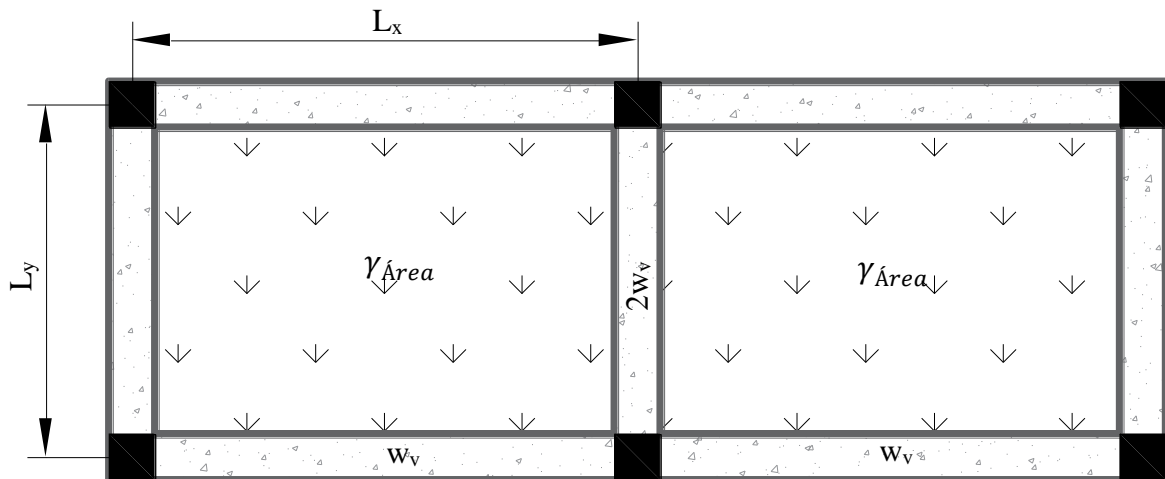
Carga sobrepuesta en una losa y su arreglo en forma de carga distribuida sobre las vigas de la estructura.
